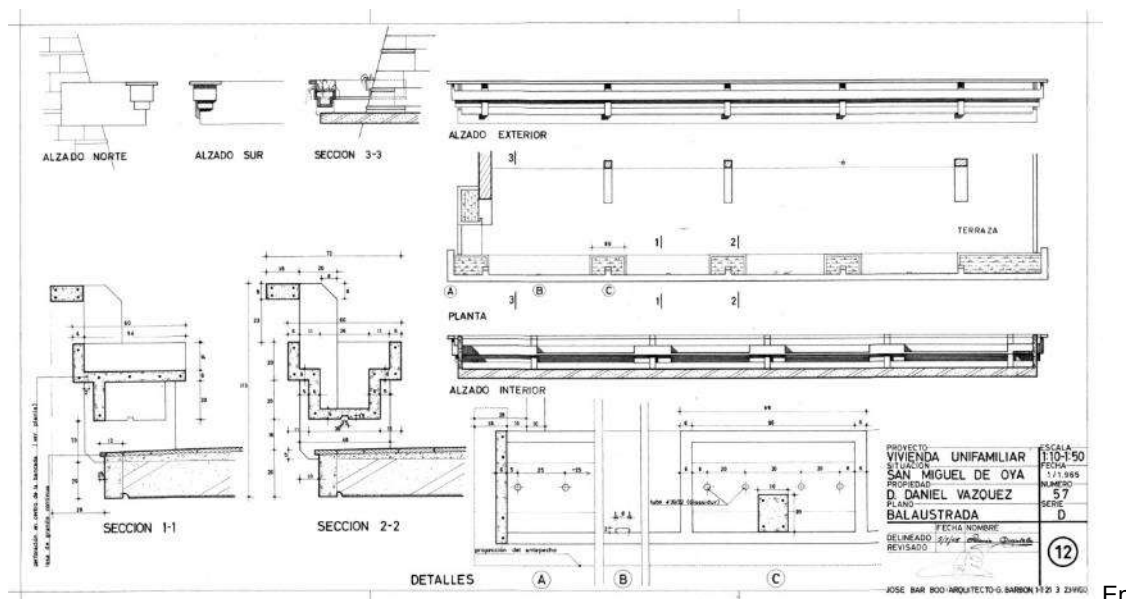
Casa Vázquez. Balaustrada. Plano 12. Delineado en 1965. (Archivo X.B.B.: Proyecto nº 57).
